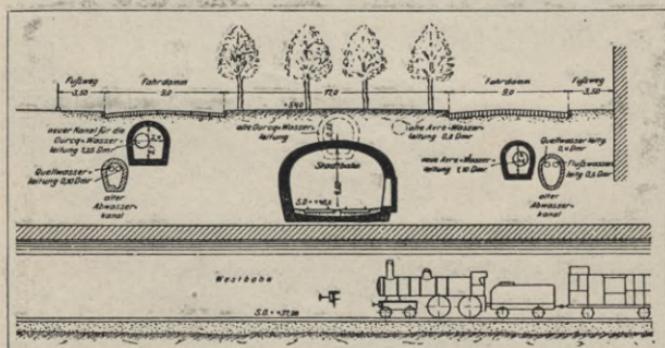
Durchschnitt durch eine Pariser Straße mit unterirdischen Anlagen.
